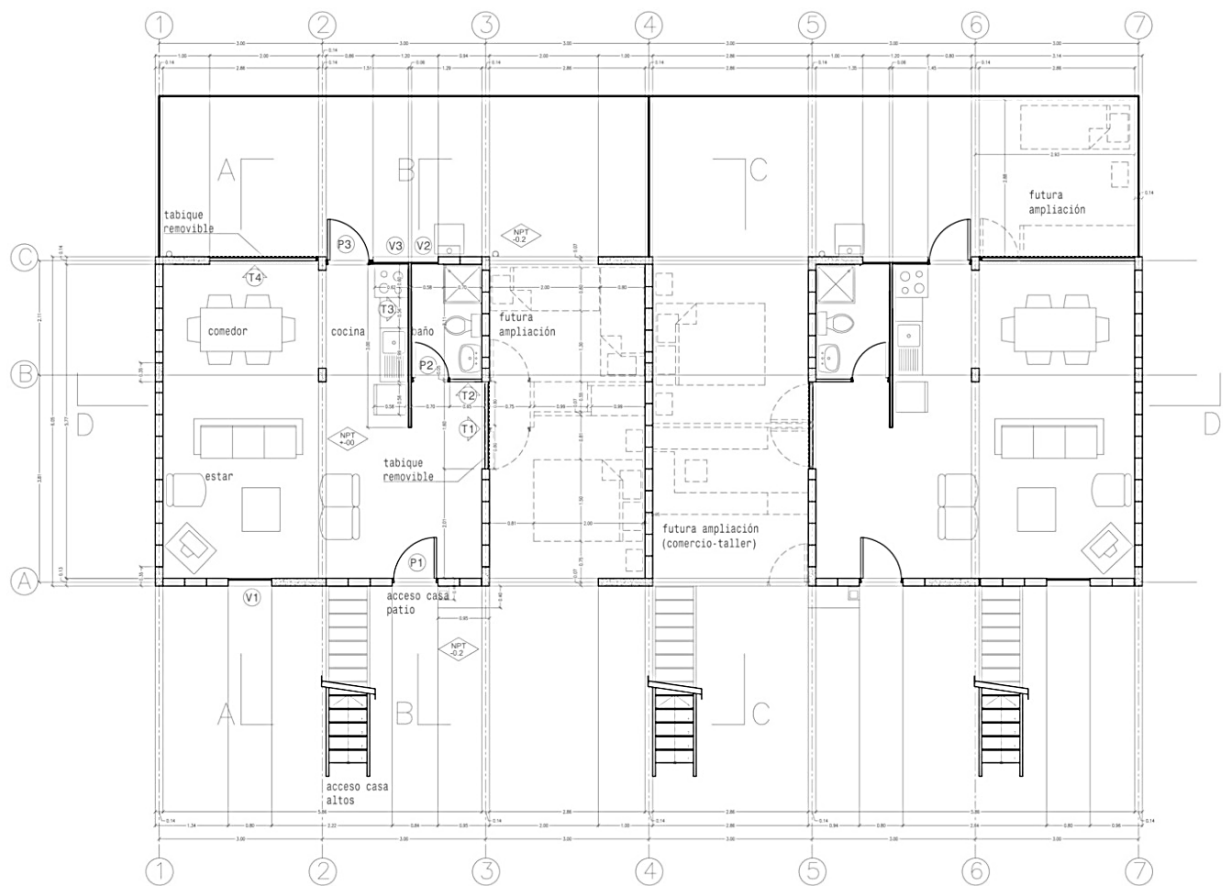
Plano arquitectónico, Villa Monroy.
